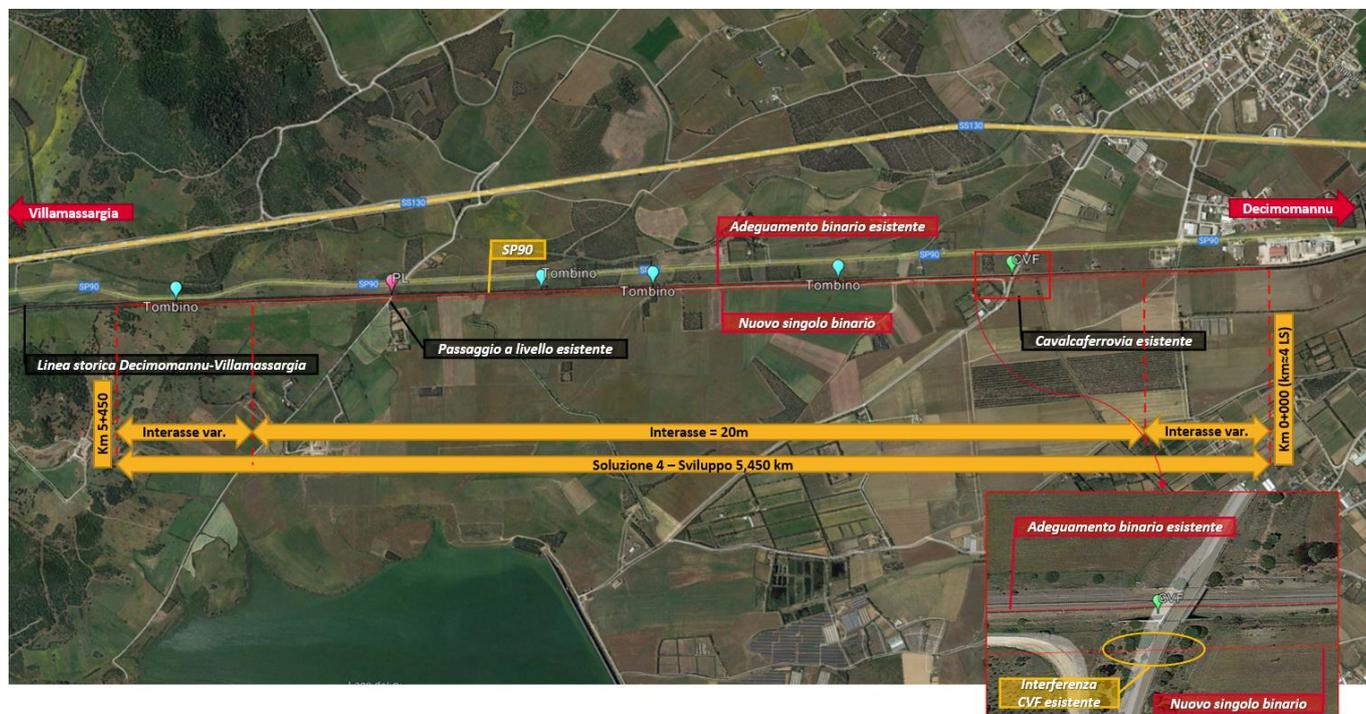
Planimetria soluzione 4 - raddoppio a sud ad interasse 20.00m e innalzamento del piano del ferro - configurazione finale due singoli binari
